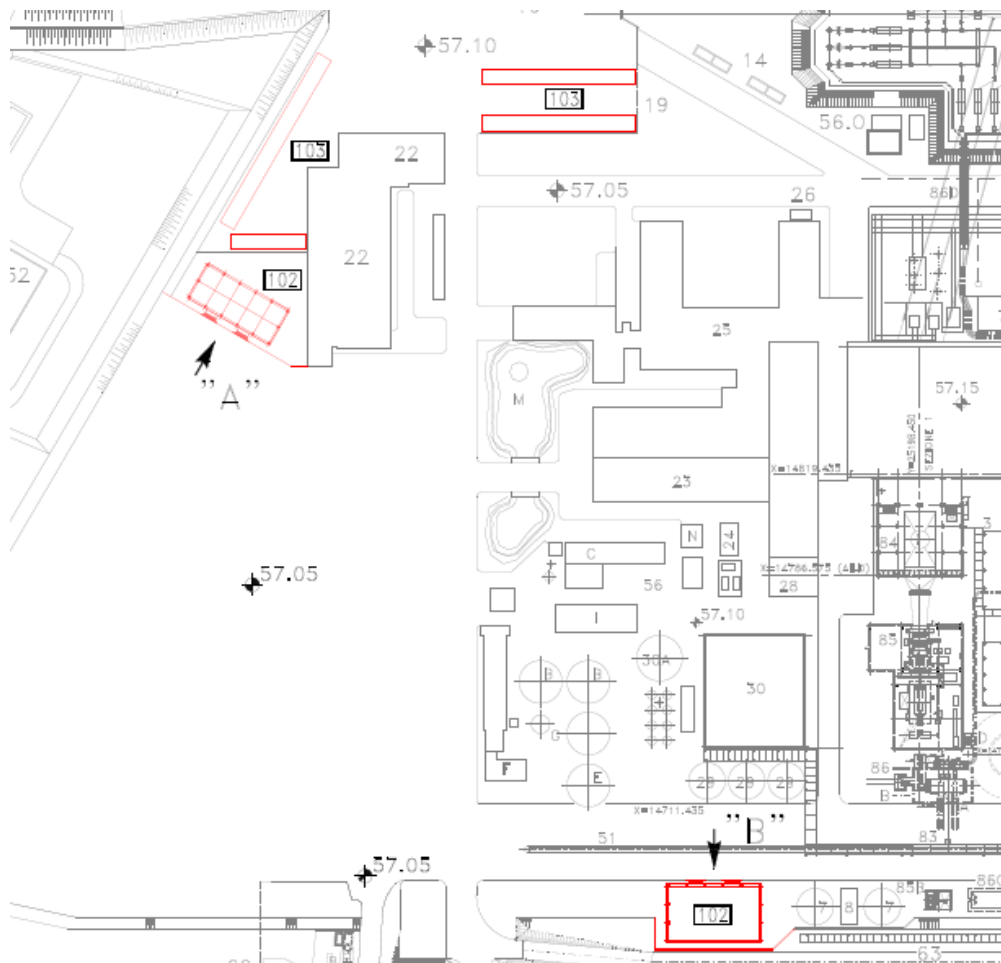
Stralcio planimetria fase “Early works” nuove realizzazioni
